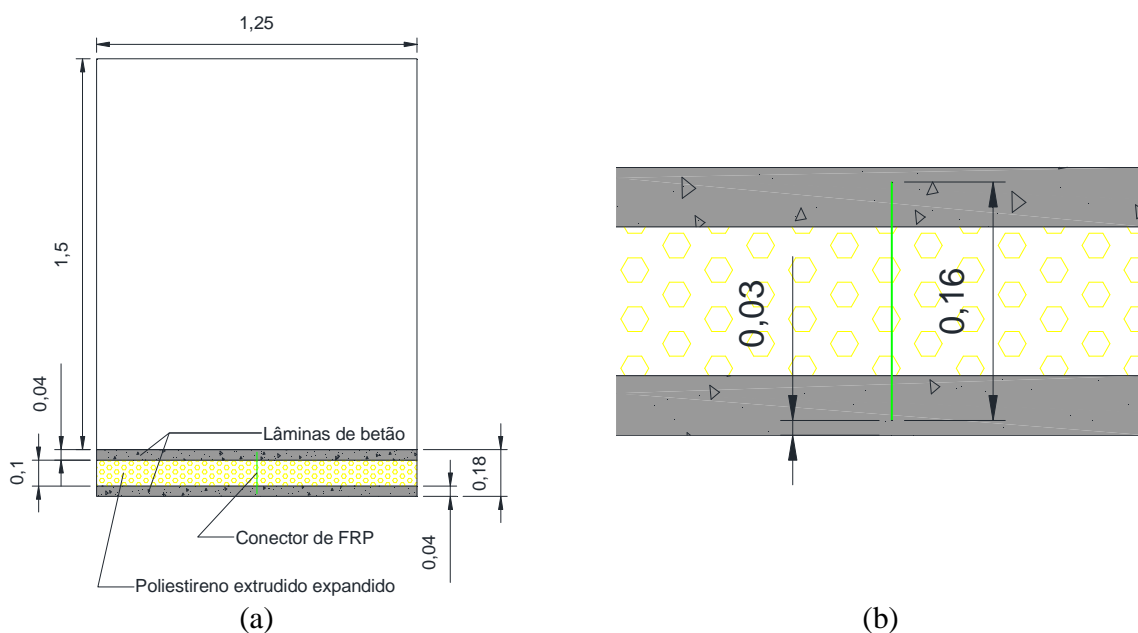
Geometria do painel sandwich com conectores treliça de FRP (vista em planta e pormenor; unidades em metros).
